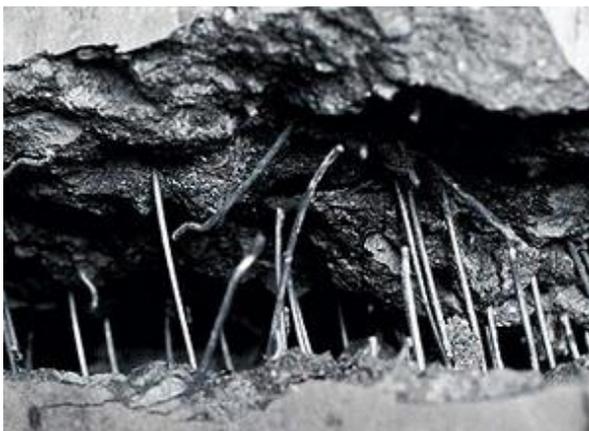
Зона образования и раскрытия трещины при разрушении фибробетона со стальными фибрами
